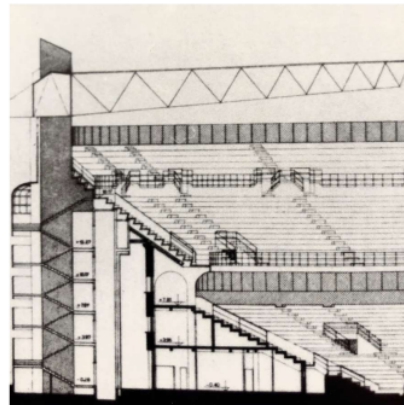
Sección de la tribuna principal del estadio con la cubierta
